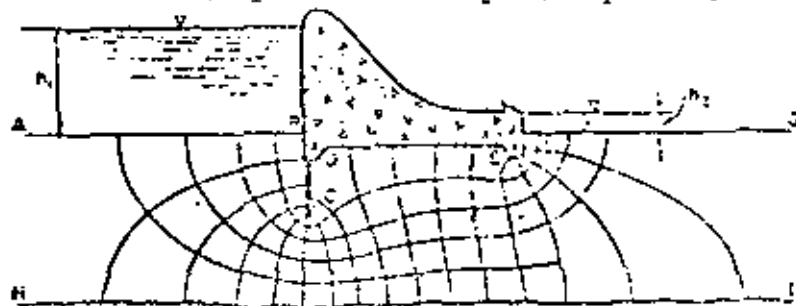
Flujo confinado bajo la cimentación de una estructura vertedora
